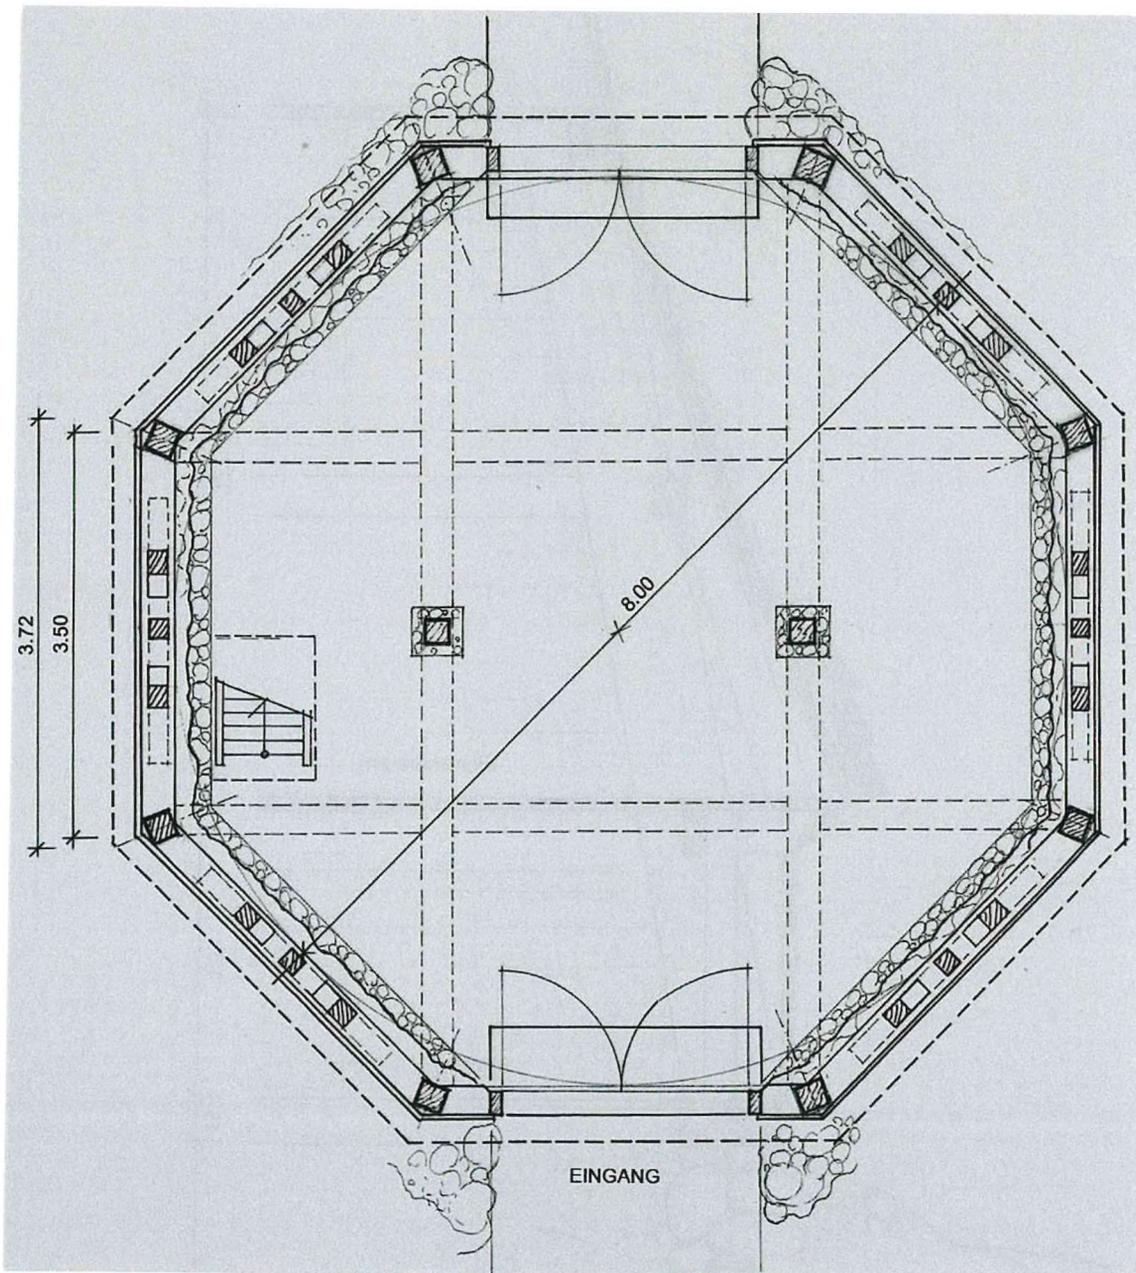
Grundriss / Schnitt durch den Mühlenschaft, ca. 1,40m über OKFF (ohne Maßstab)
